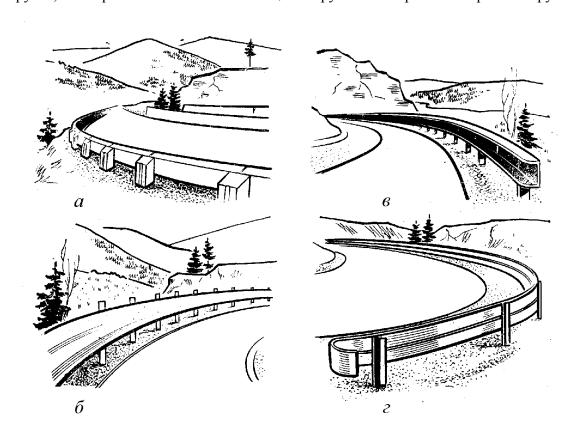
Барьерные ограждения: a – железобетонные; δ , ϵ , ϵ – металлические
